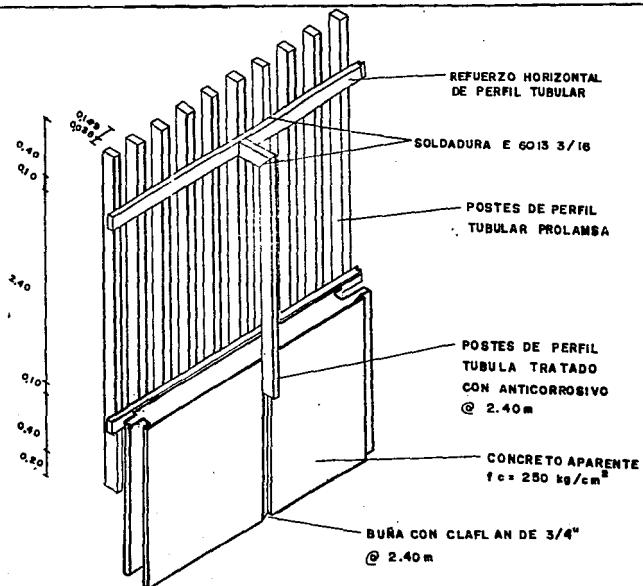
ISOMETRICO DE LA BARDA PERIMETRAL CON LA REJA COLOCADA.
